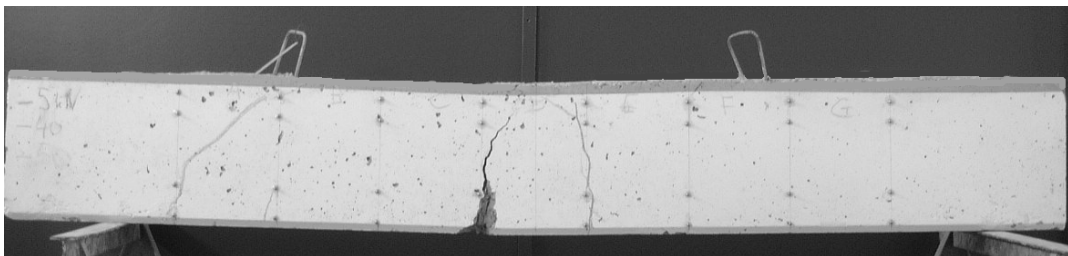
Faciès de fissuration de la poutre ADHCE.
